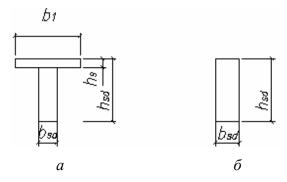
Расчетные сечения второстепенных балок: a — в пролете; δ — на опоре
